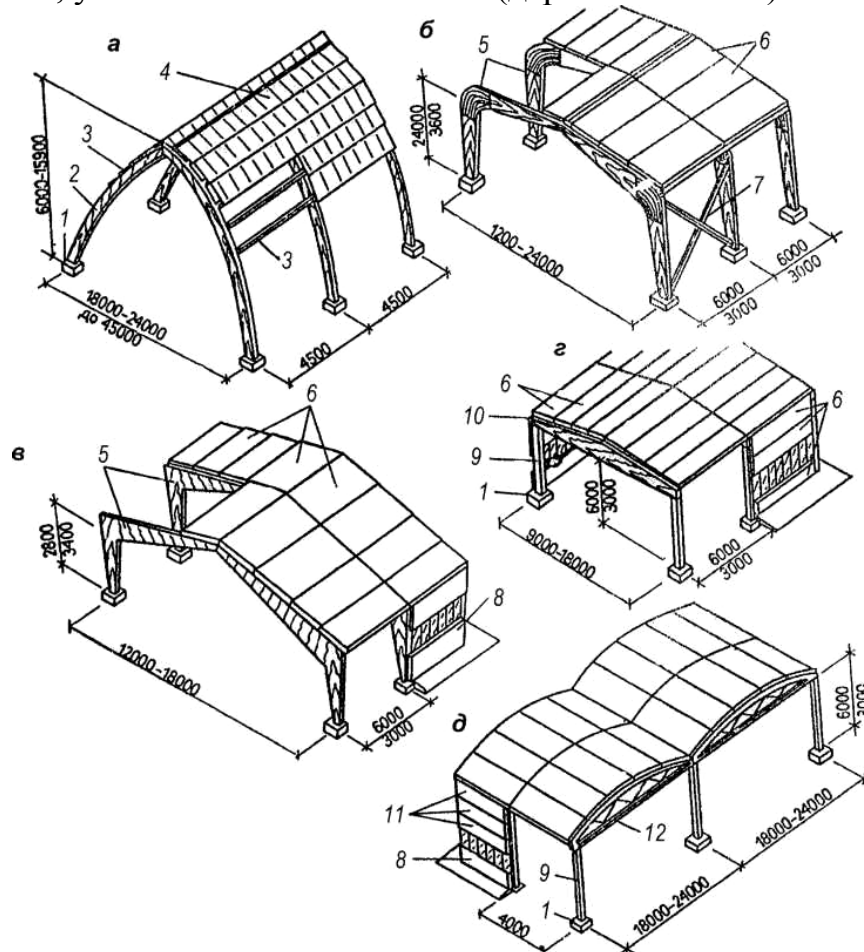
Дерев'яні каркаси промислових будівель: а – зі стрілочастих арок; б – з гнукотесених рам; в – з рам, з'єднаних у карнизному вузлі в зубчастий шип; г – стійково-балковий; д – із кроквяними фермами; 1 – фундаменти; 2 – арка; 3 – обрешітка; 4 – хвилясті азбоцементні листи; 5 – рами; 6 – клеєфанерні плити покриття; 7 – вертикальні зв'язки; 8 – стінові азбоцементні панелі; 9 – дерев'яні стійки; 10 – двосхилі балки; 11 – клеєфанерні панелі стін; 12 – сегментна ферма
